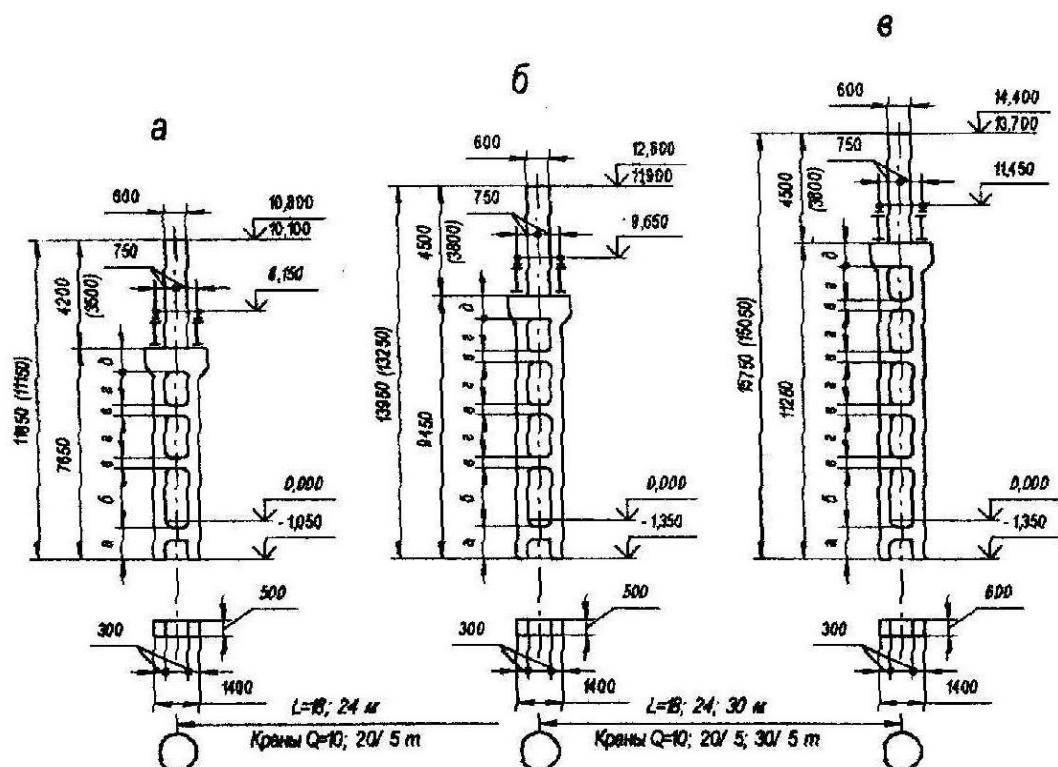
Габаритные размеры железобетонных колонн, мм, крайнего ряда:
